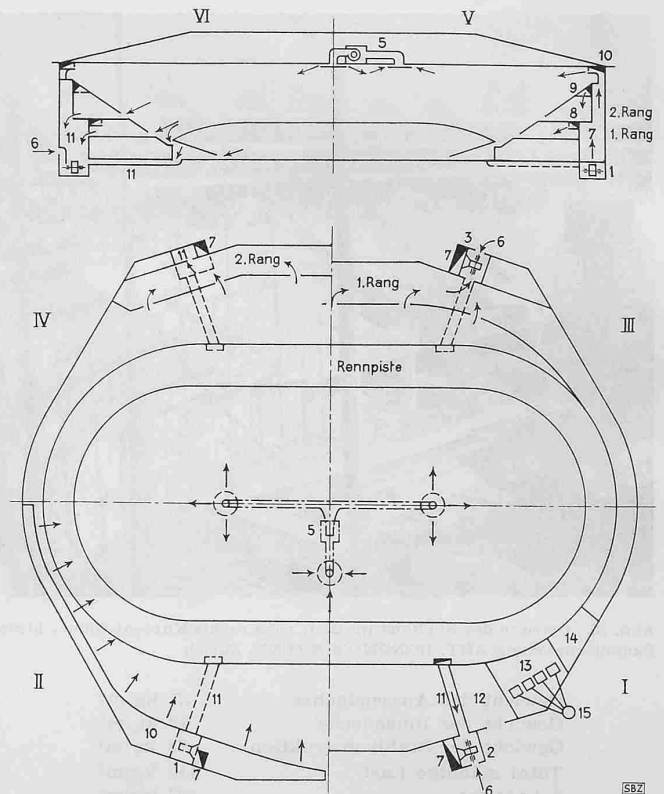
Ventilationsschema, I Grundriss Erdgeschoss, II Grundriss auf der Höhe des Ringkanals 10 unter der Decke, III Grundriss 1. Rang, IV Grundriss 2. Rang, V Querschnitt durch den Zuluftschacht, VI Querschnitt durch den Umluftschacht. 1 Ventilator, 2 Saugkammer, 3 Druckkammer, 5 Dachheizanlage, 6 Frischlufteintritt, 7 Zuluftschächte, 8 Zuluft-Verteilkanal 1. Rang, 9 Zuluft-Verteilkanal 2. Rang, 10 Zuluft-Ringkanal, 11 Rückluftkanal, 12 Kohlen, 13 Kessel, 14 Heizwasser-Pumpe und Verteilbatterie, 15 Hochkamin
